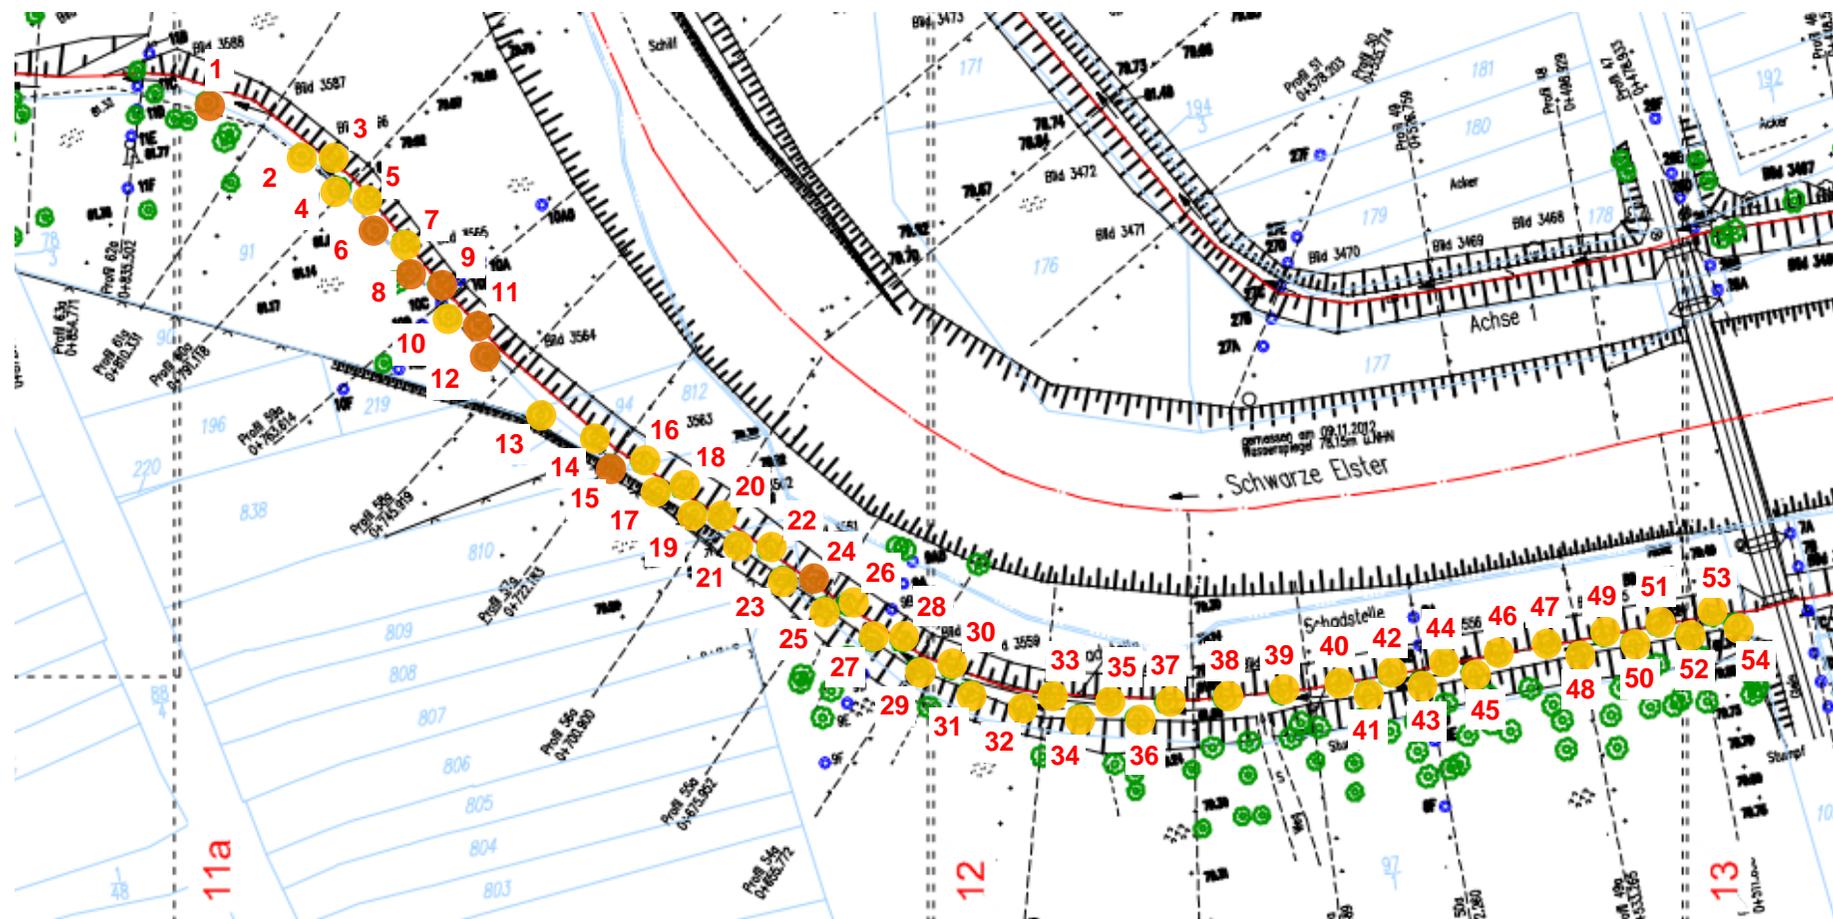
Lageplan Lindenallee, Bäume Nr. 1 – 54 (Straßenbrücke B 87 bis Eisenbahnbrücke).
